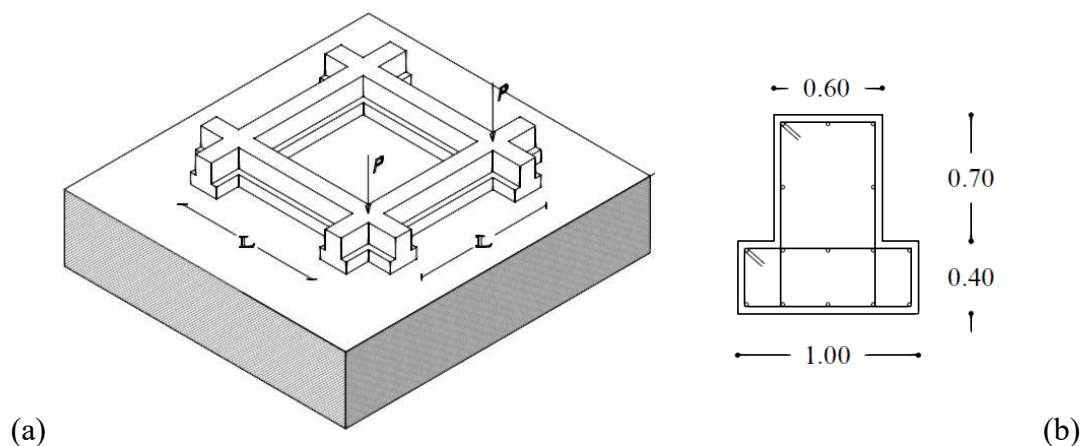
Grigliato di travi di fondazione soggetto due carichi concentrati. Vista tridimensionale (a); dimensioni (in metri) sezione trasversale delle travi (b).
